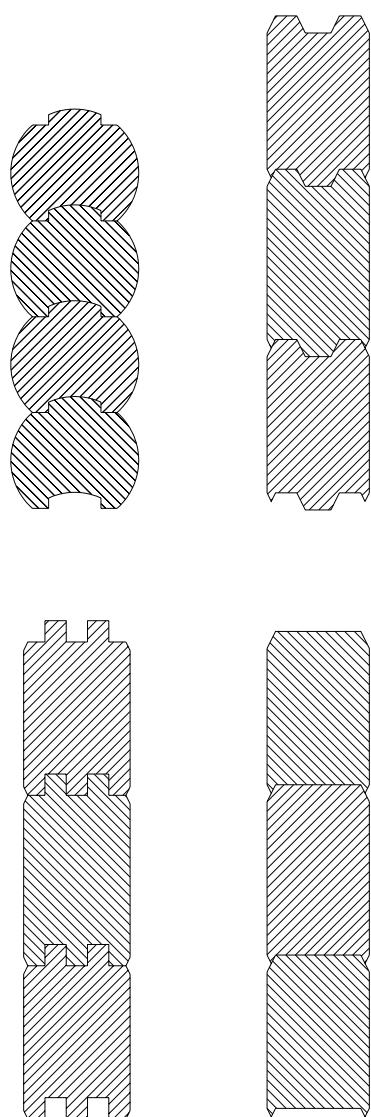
Secções tipo de paredes de troncos com encaixes
